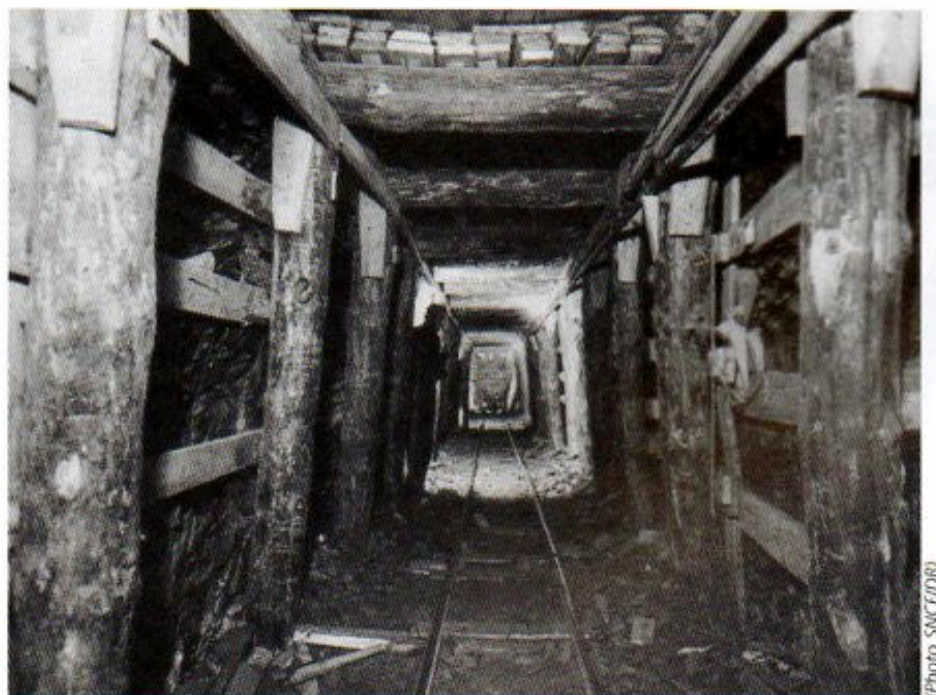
Galerie boisée avec fléchissement des porteurs, Tunnel de Monte Carlo
